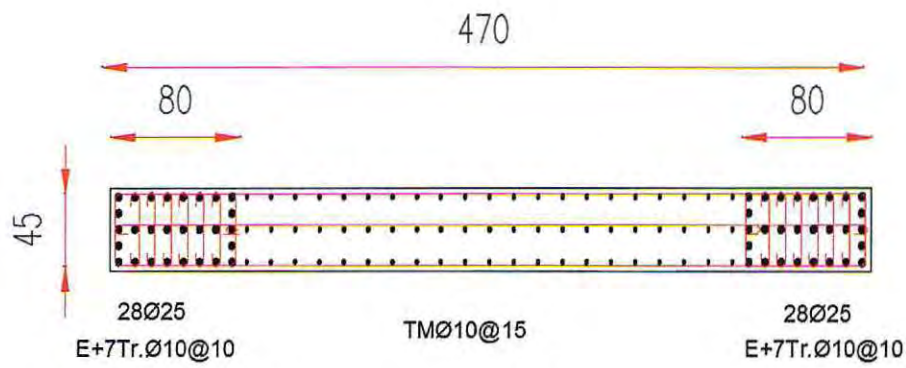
Disposición armadura Ed. Tradicional muro "R".
